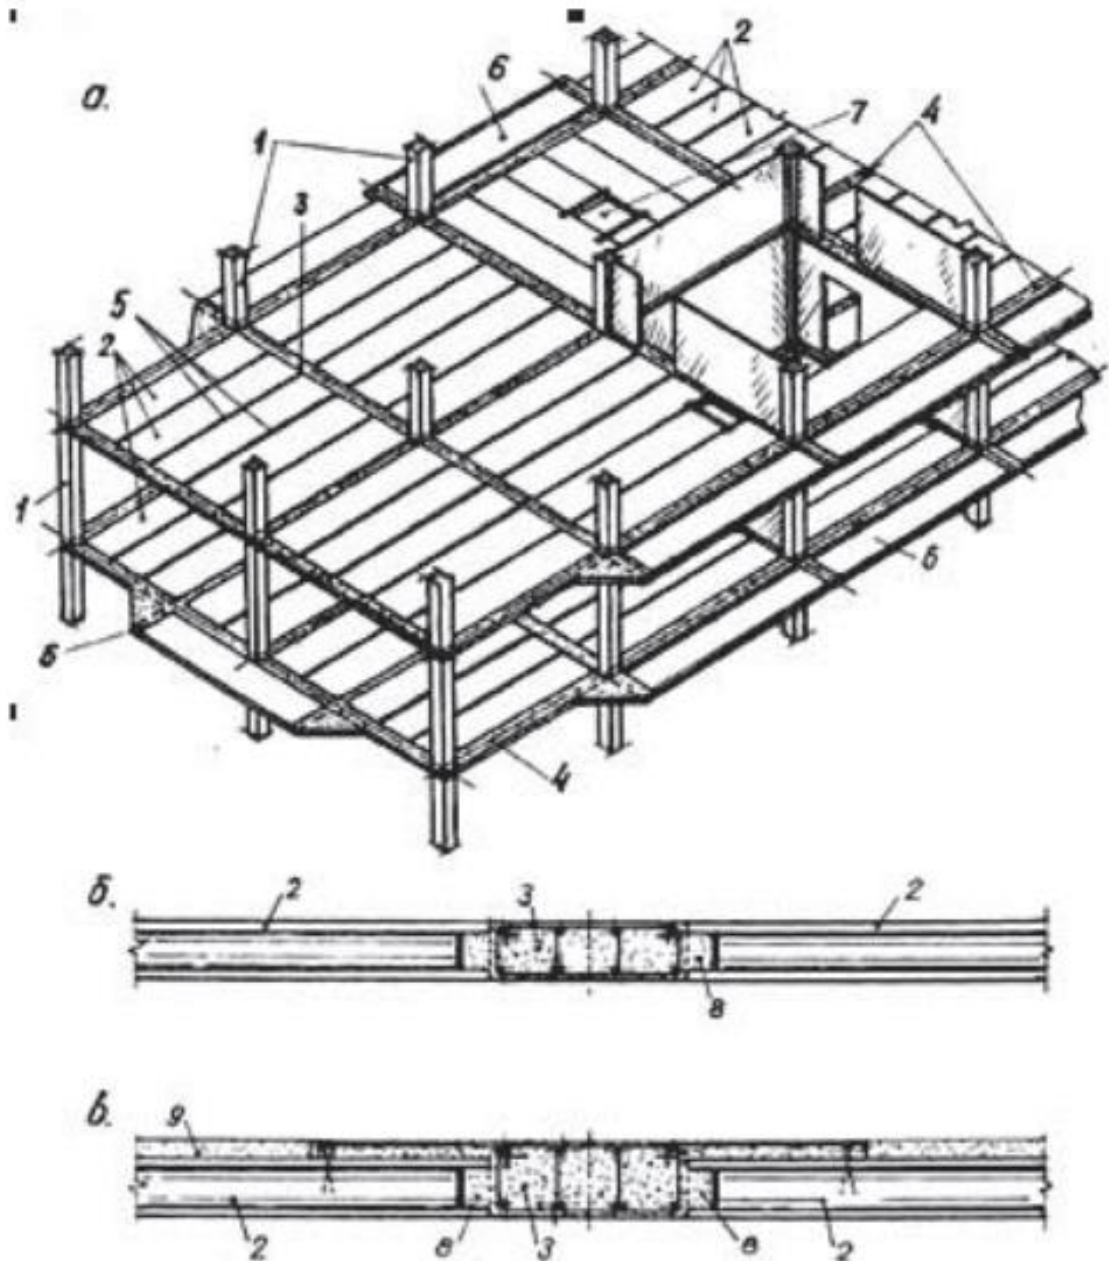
Конструкція збірно-монолітного каркасу будівлі білоруської системи «АРКОС»: *а* – загальний вид каркасу; *б, в* – розрізи; 1 - залізобетонні збірні колони; 2 - залізобетонні збірні багатопустотні плити; 3 – несучі ригелі; 4 – зв'язуючі ригелі; 5 – замонолічені шви між плитами; 6 – консолі для улаштування еркерів і балконів; 7 – монолітні ділянки перекрить; 8 – несучі шпонки; 9 – збільшена висота ригелів
